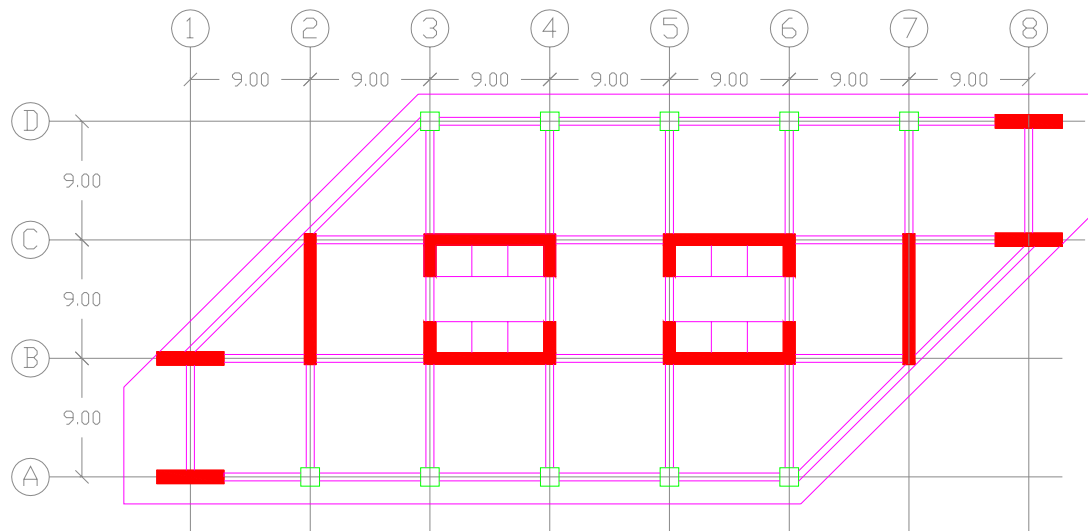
Planta Torre Banap. Simetría en núcleos de ascensores
